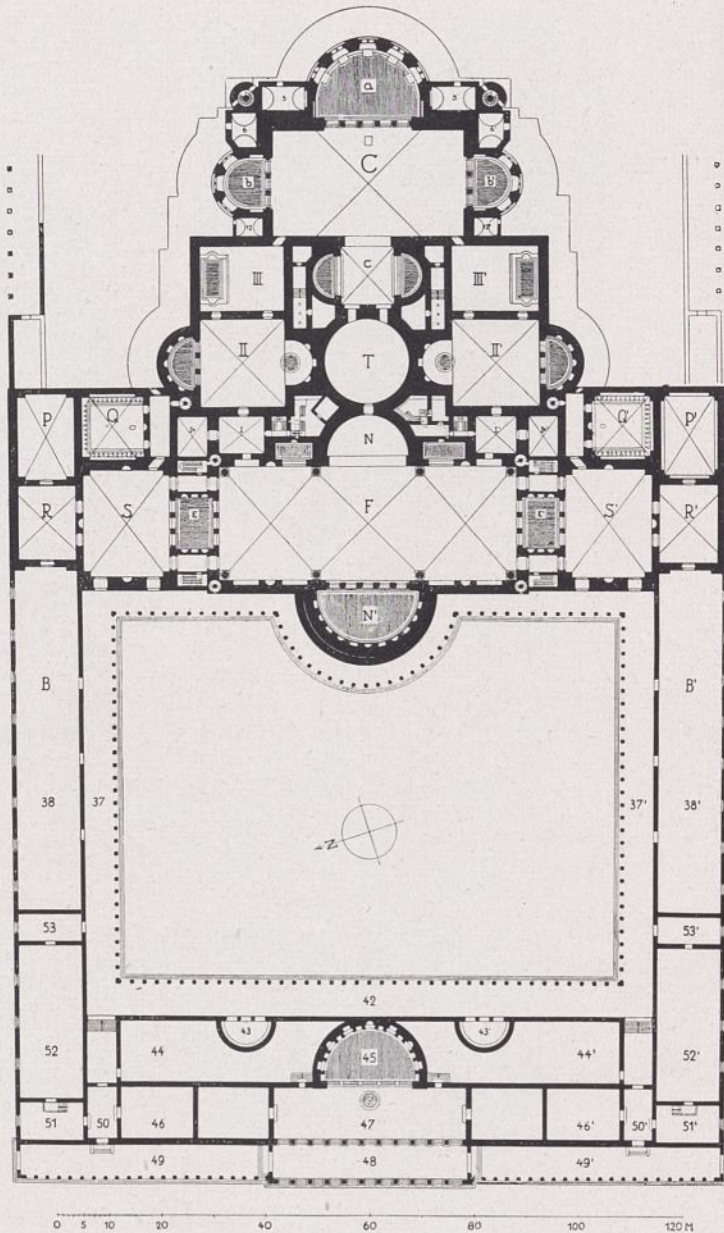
Erdgeschoß der Kaiserthermen. Rekonstruktion von D. Krencker.
